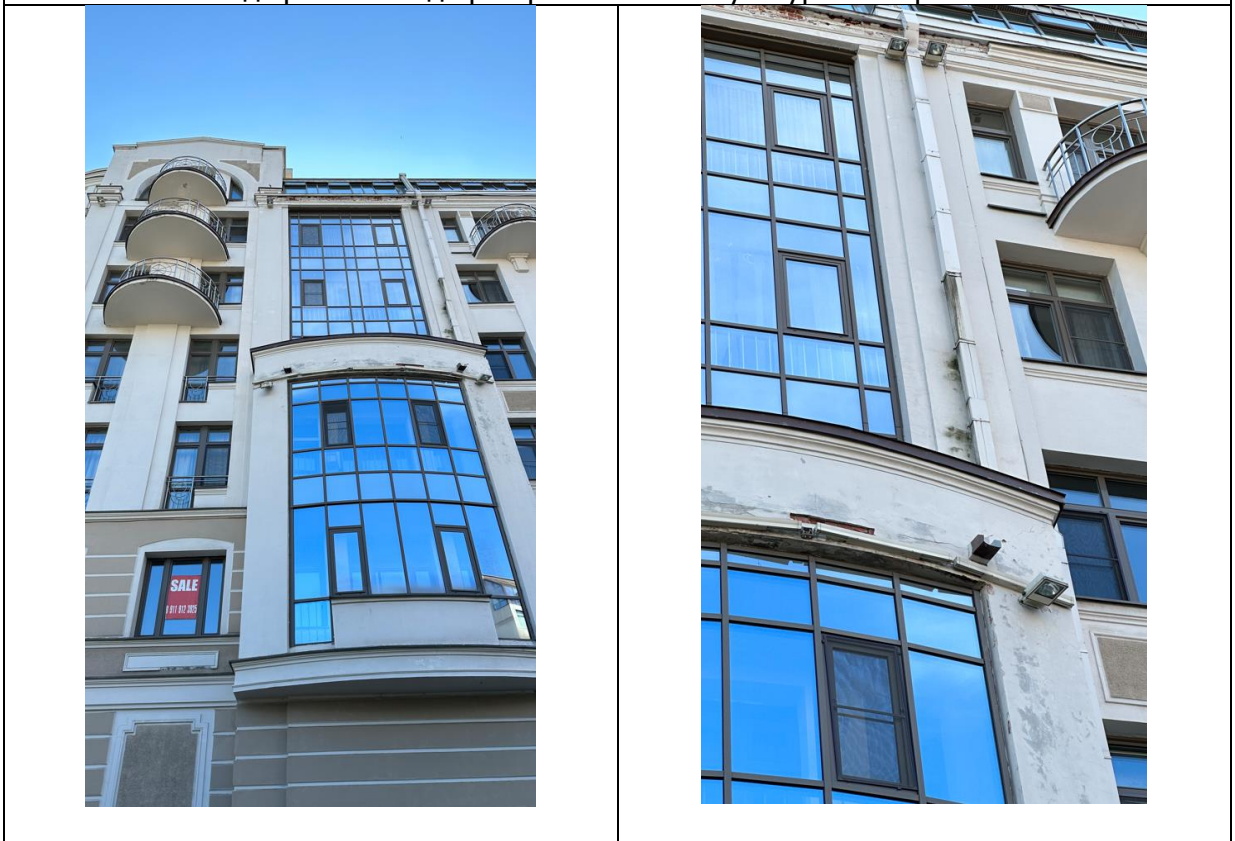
Вид дефектов фасада в виде отслоения штукатурки на откосах и балконах
